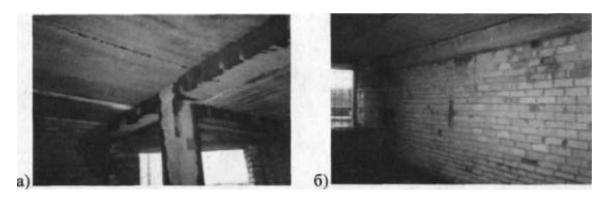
Стадия строительства многоэтажного жилого дома со сборным каркасом серии 1.080–1/83. Нижняя поверхность междуэтажных перекрытий а – узел сопряжения ригелей с колоннами;
